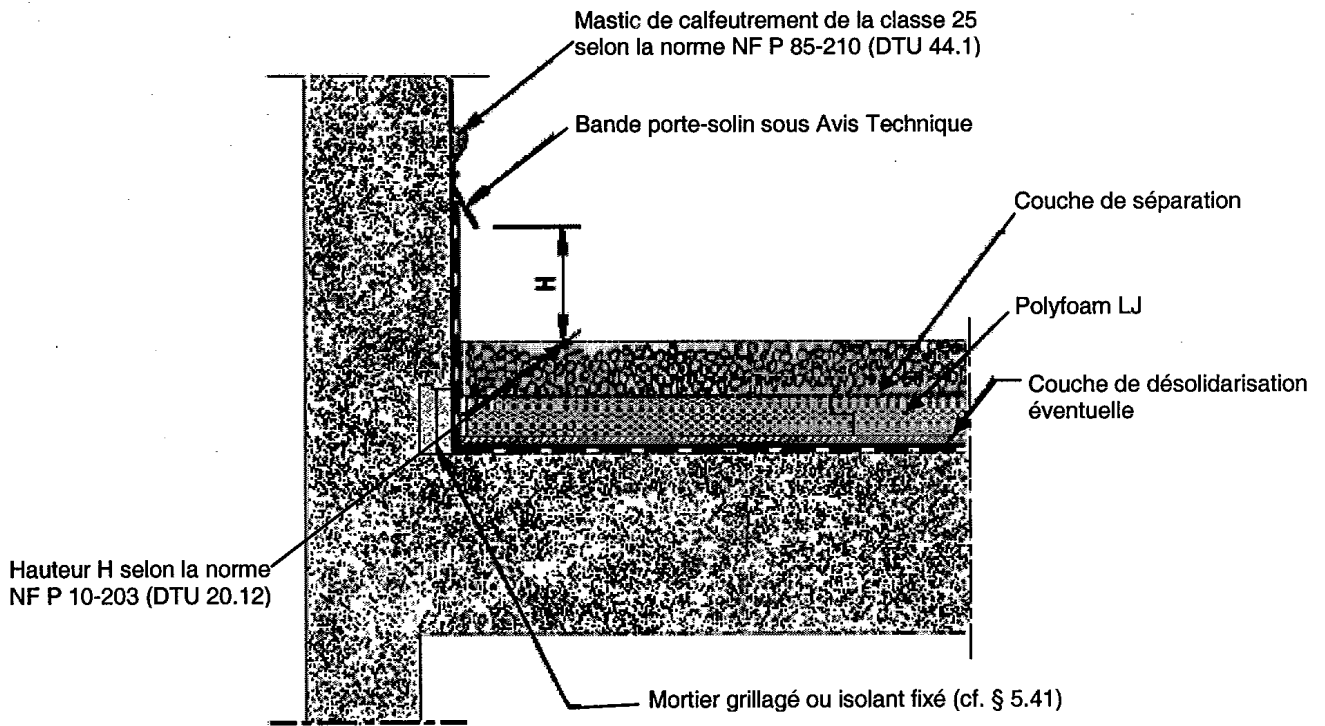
Toiture existante, rehaussement du relevé d'étanchéité avec mortier grillagé
